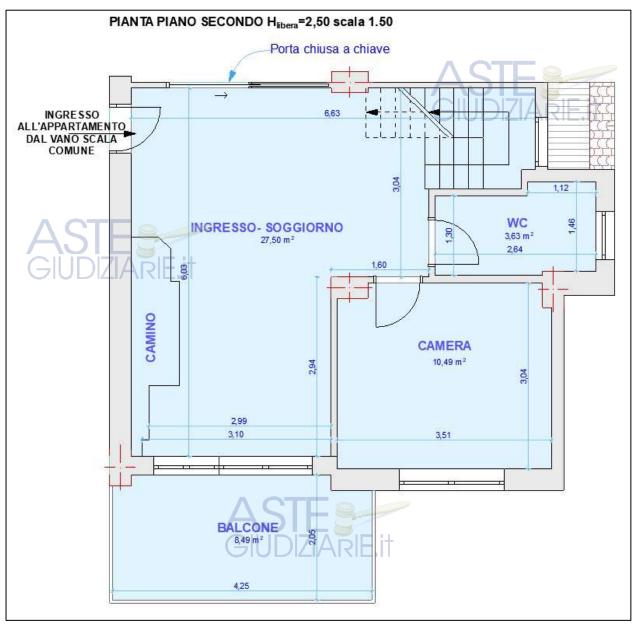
Rilievo metrico dell'appartamento pignorato con indicazione delle superfici nette – piano secondo.
